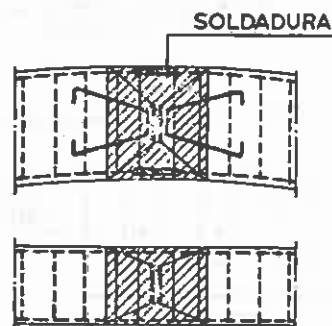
Pormenor de apoio fixo de arco atirantado com articulação de betão armado
